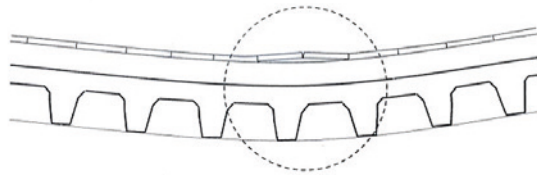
Esquema del levantamiento de las piezas originado por la flexión del forjado en el centro del vano.
